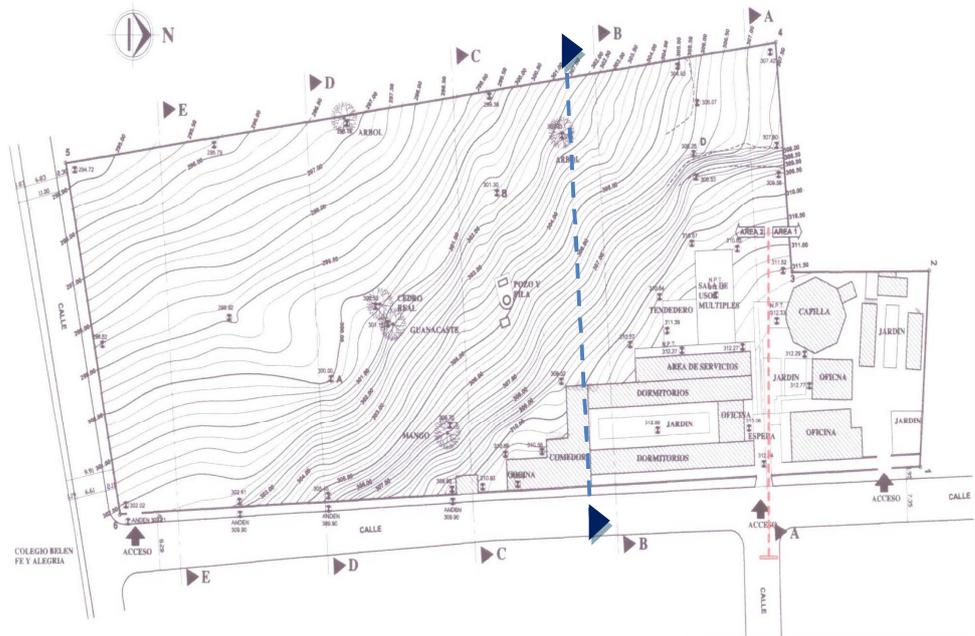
Planta de conjunto Actual. /Fuente: Propia.
